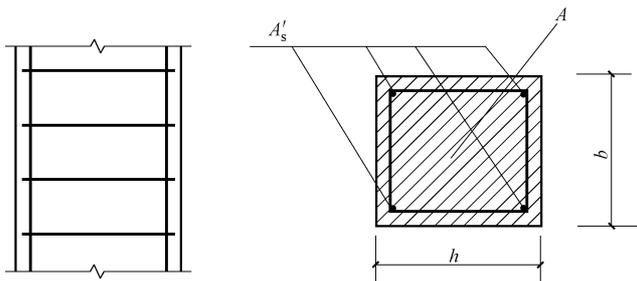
配置箍筋的钢筋混凝土轴心受压构件
